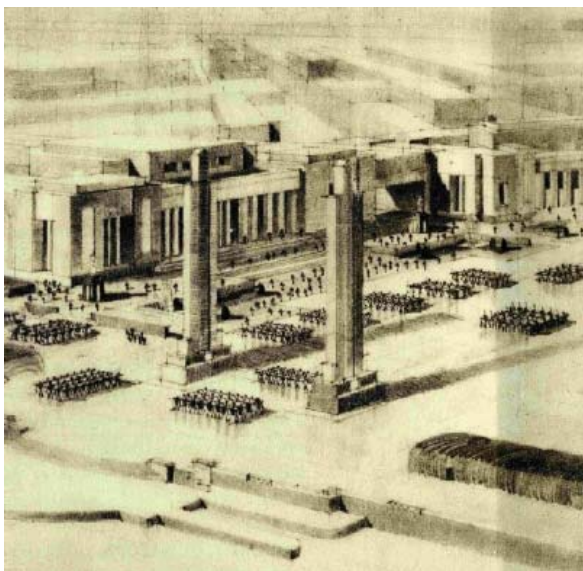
Plano Agache, Entrada do Brasil, detalhe
